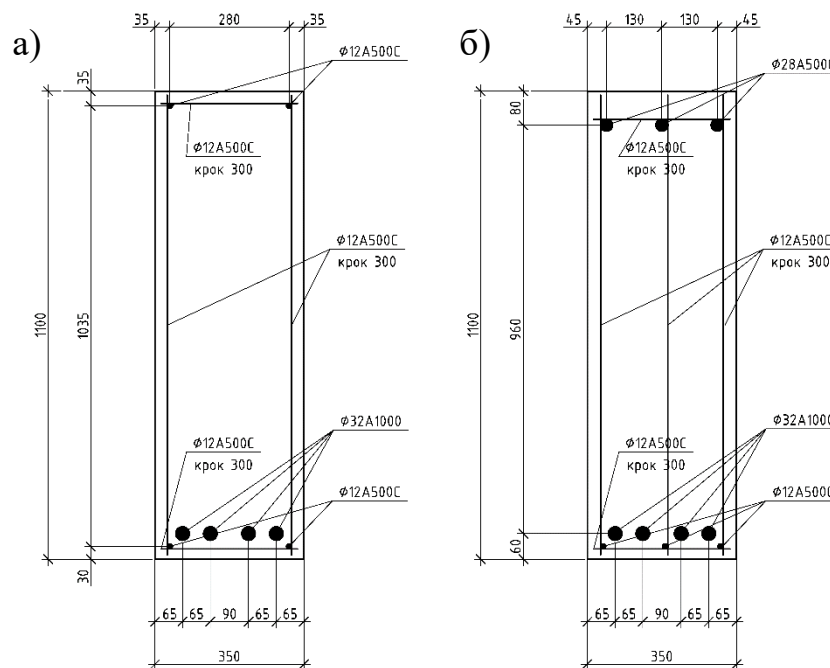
Схема армування ригеля: а – у середині прольоту; б – на опори
